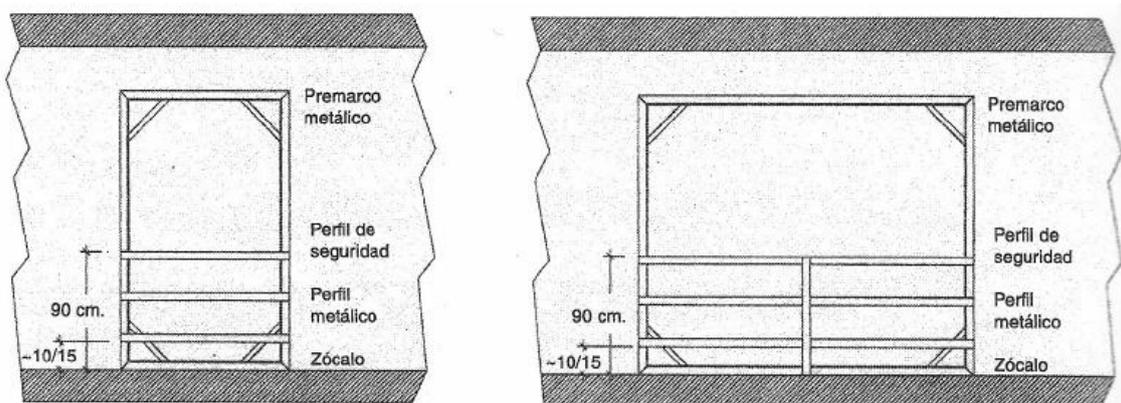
Protección mediante perfiles metálicos soldados en taller a los premarcos de la carpintería metálica.
